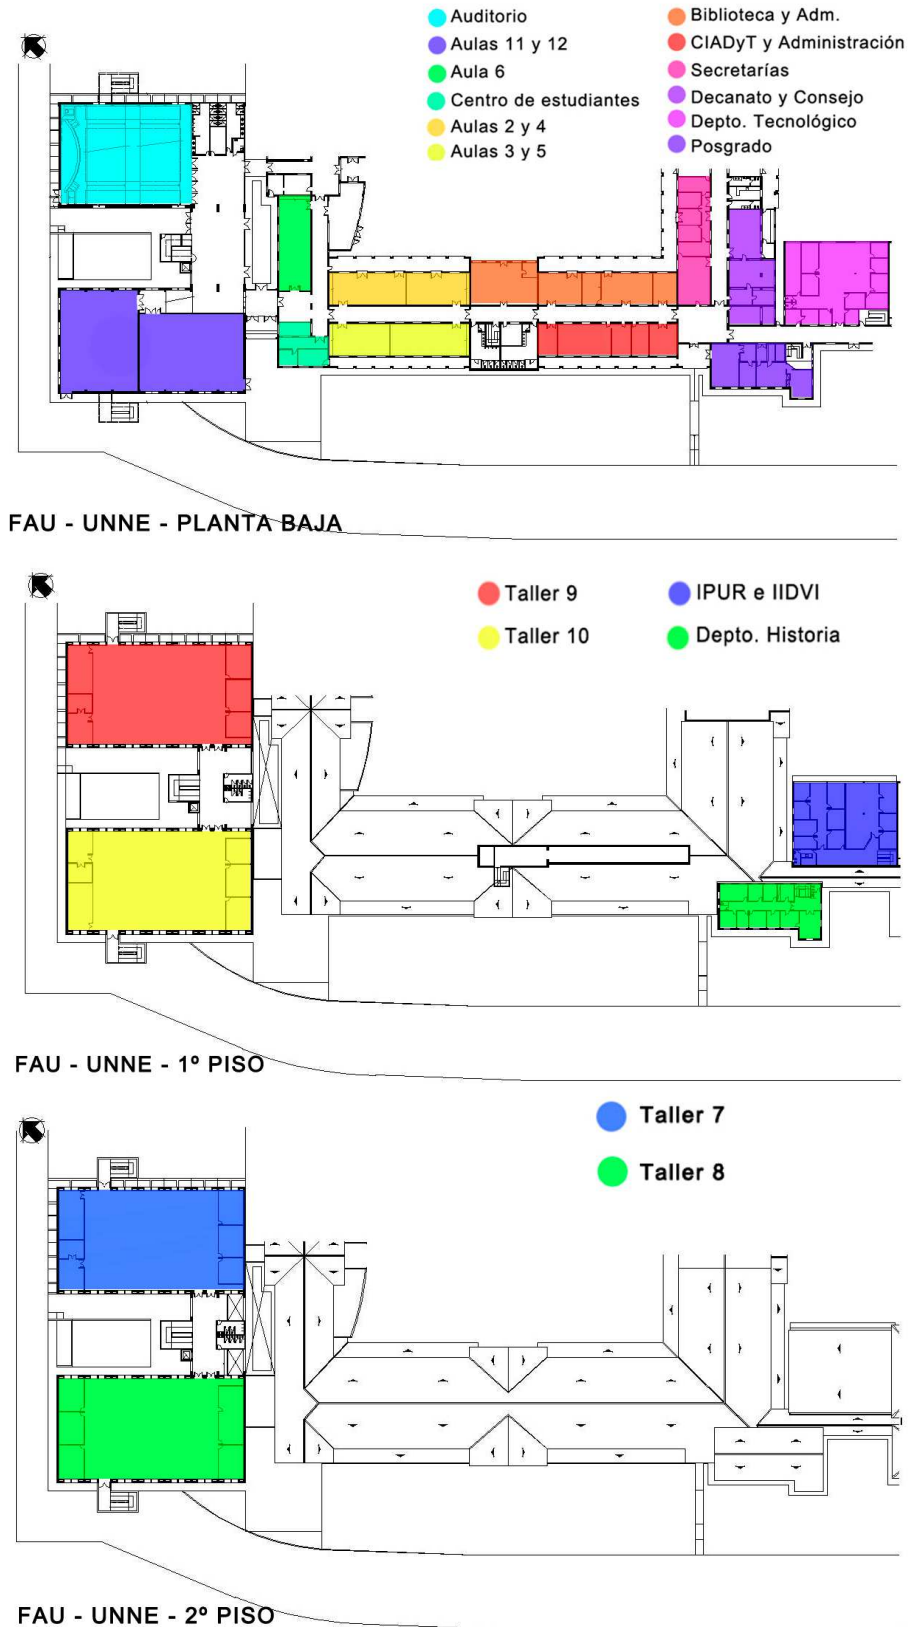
Planta baja, primera y segundo piso de la sede edilicia de la FAU-UNNE.
